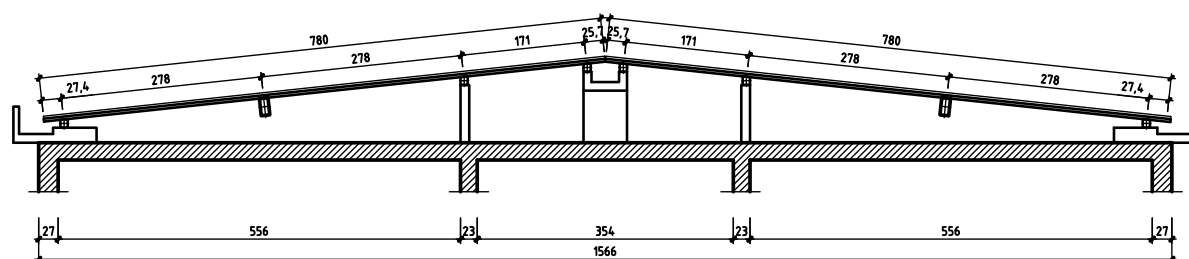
Sezione trasversale dell'edificio in corrispondenza della parte centrale della copertura.
